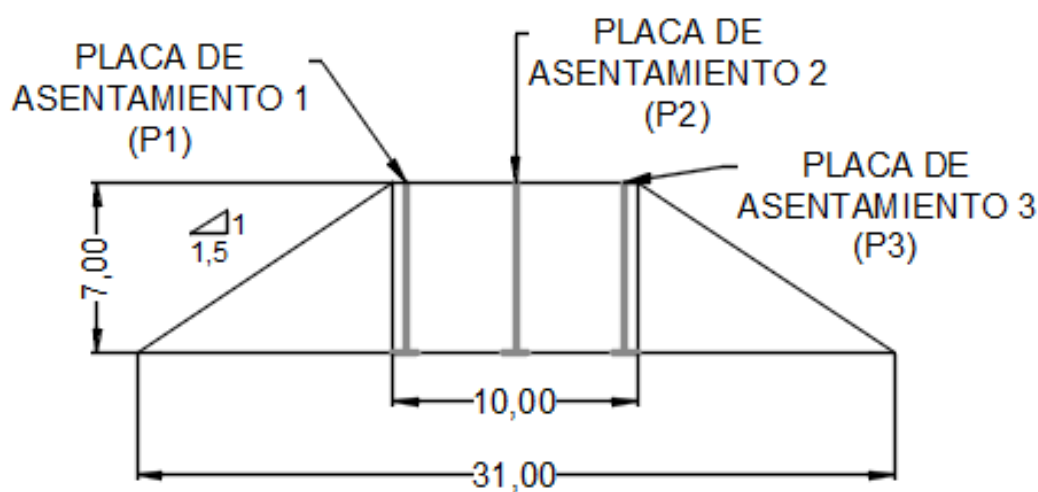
Propuesta de Instrumentación en terraplén - Perfil.
